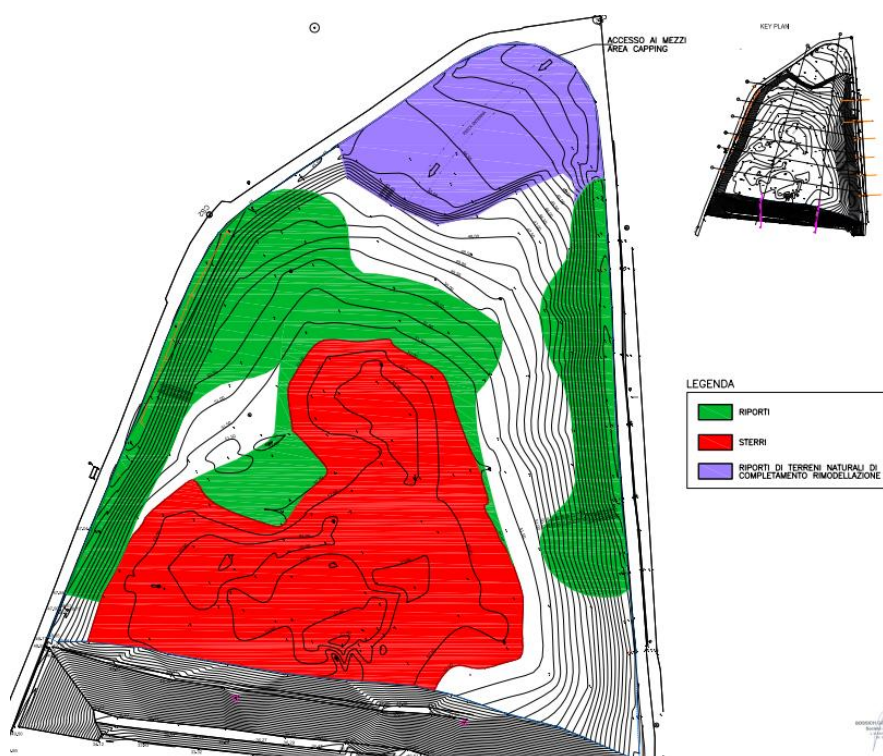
Estratto tavola 7P-Planimetria con sterri e riporti sezioni longitudinali 7-8 (Bossich Geoengineer)
